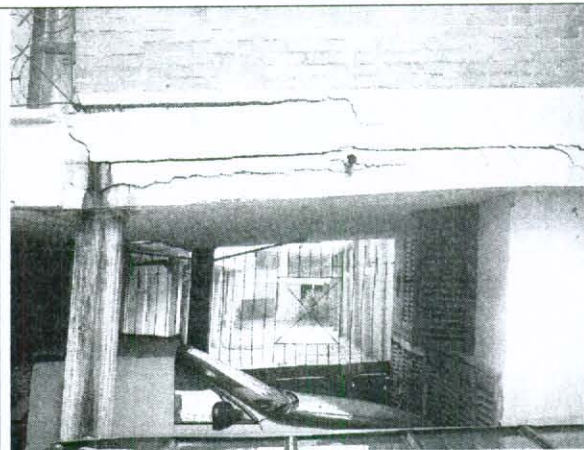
Fractura de elementos estructurales (Costado Sur Oriental).
